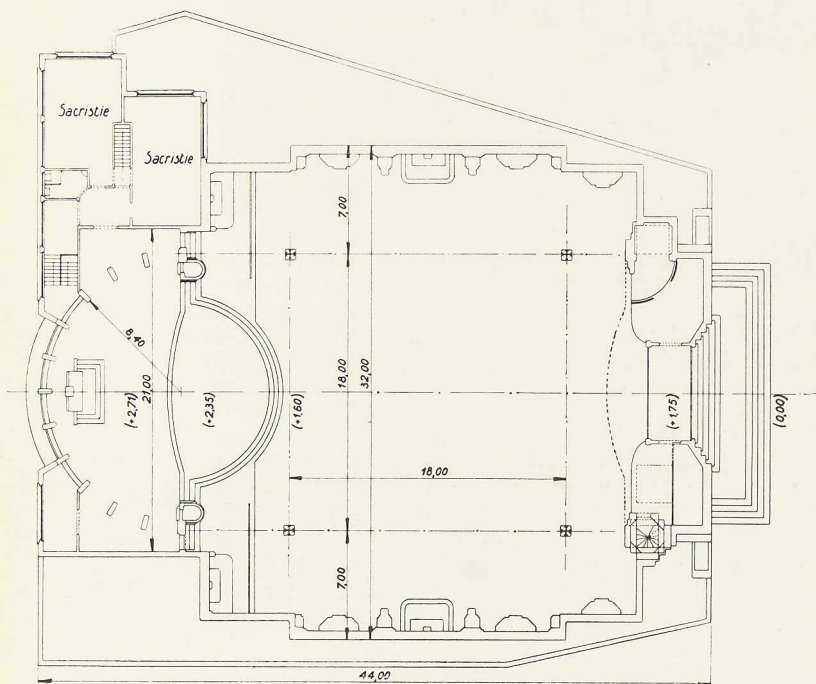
Plancher au-dessus du niveau du pavement du chœur.
